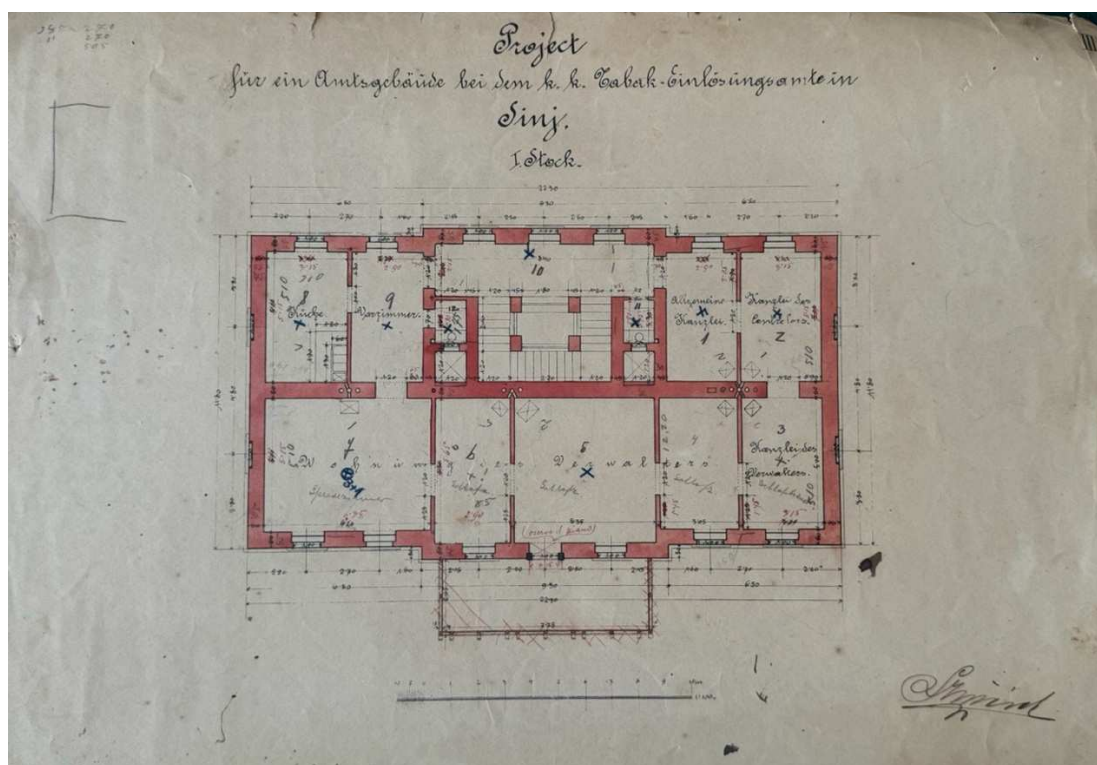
Verwaltungsgebäude in Sinj, Grundriss, 1897.
